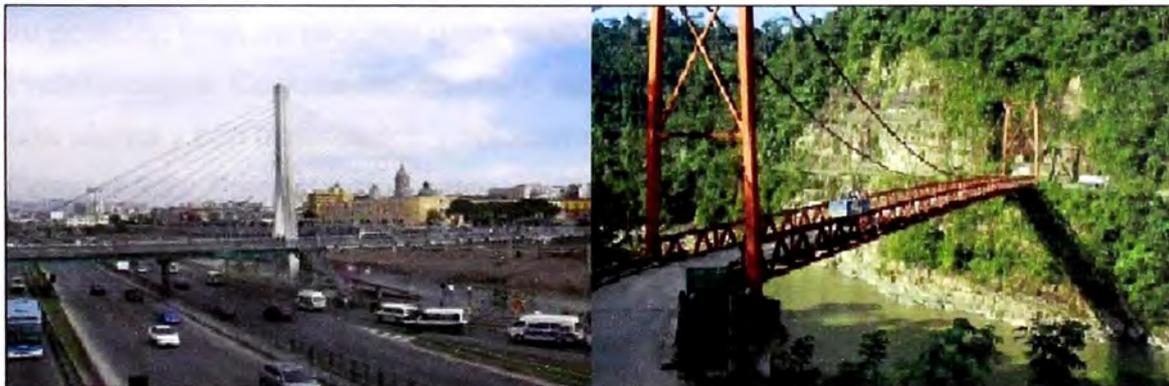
Tipos de puente según la sección de la superestructura.
